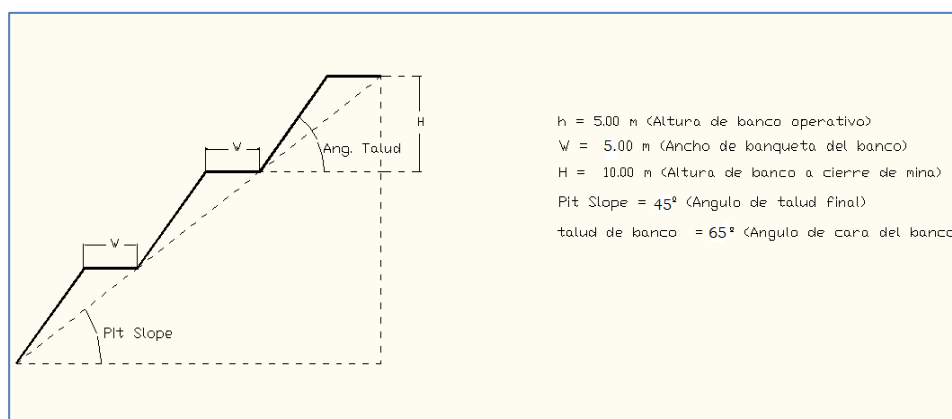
Parámetros de diseño del Pit. Fuente: Plan de minado año 2017 (CIEMSA, 2017)
